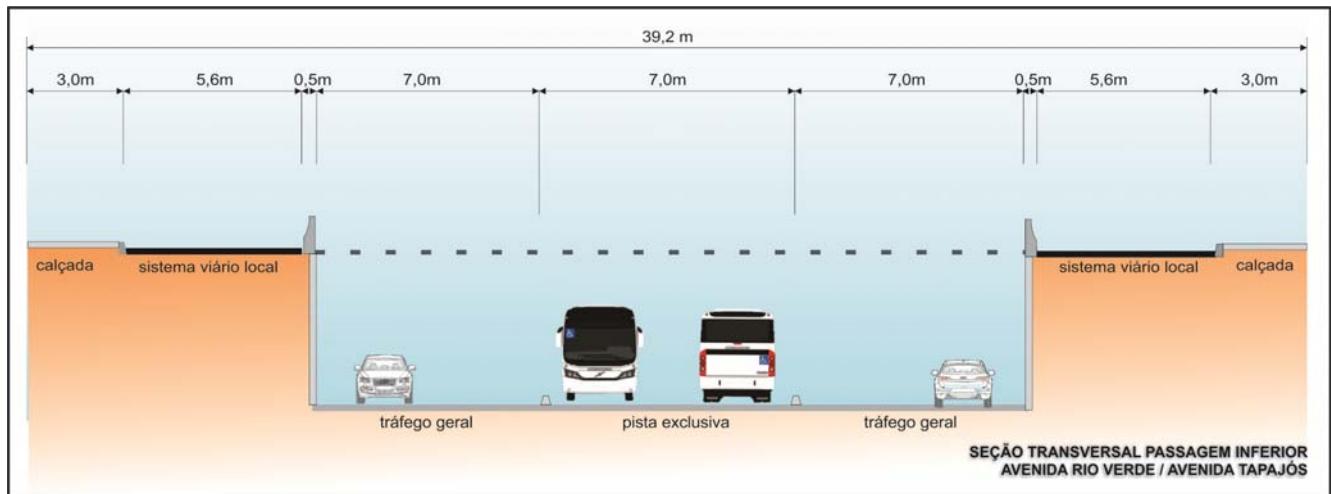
Seção transversal passagem inferior Avenida Rio Verde x Avenida Tapajós
